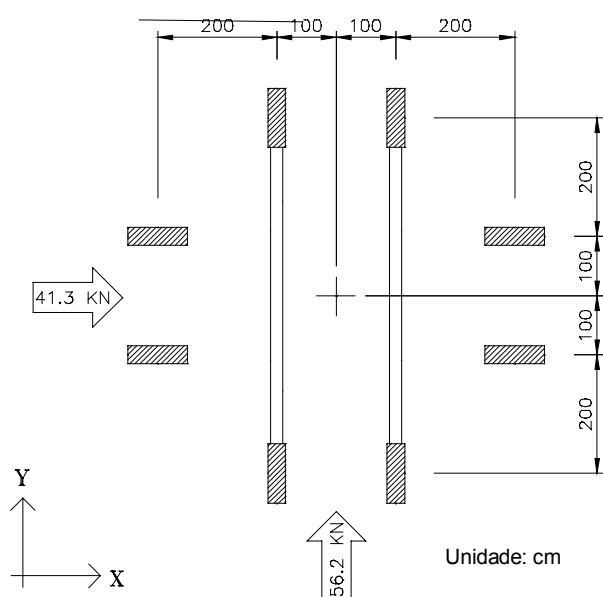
Estrutura sem consideração das vigas secundárias - caso 02
